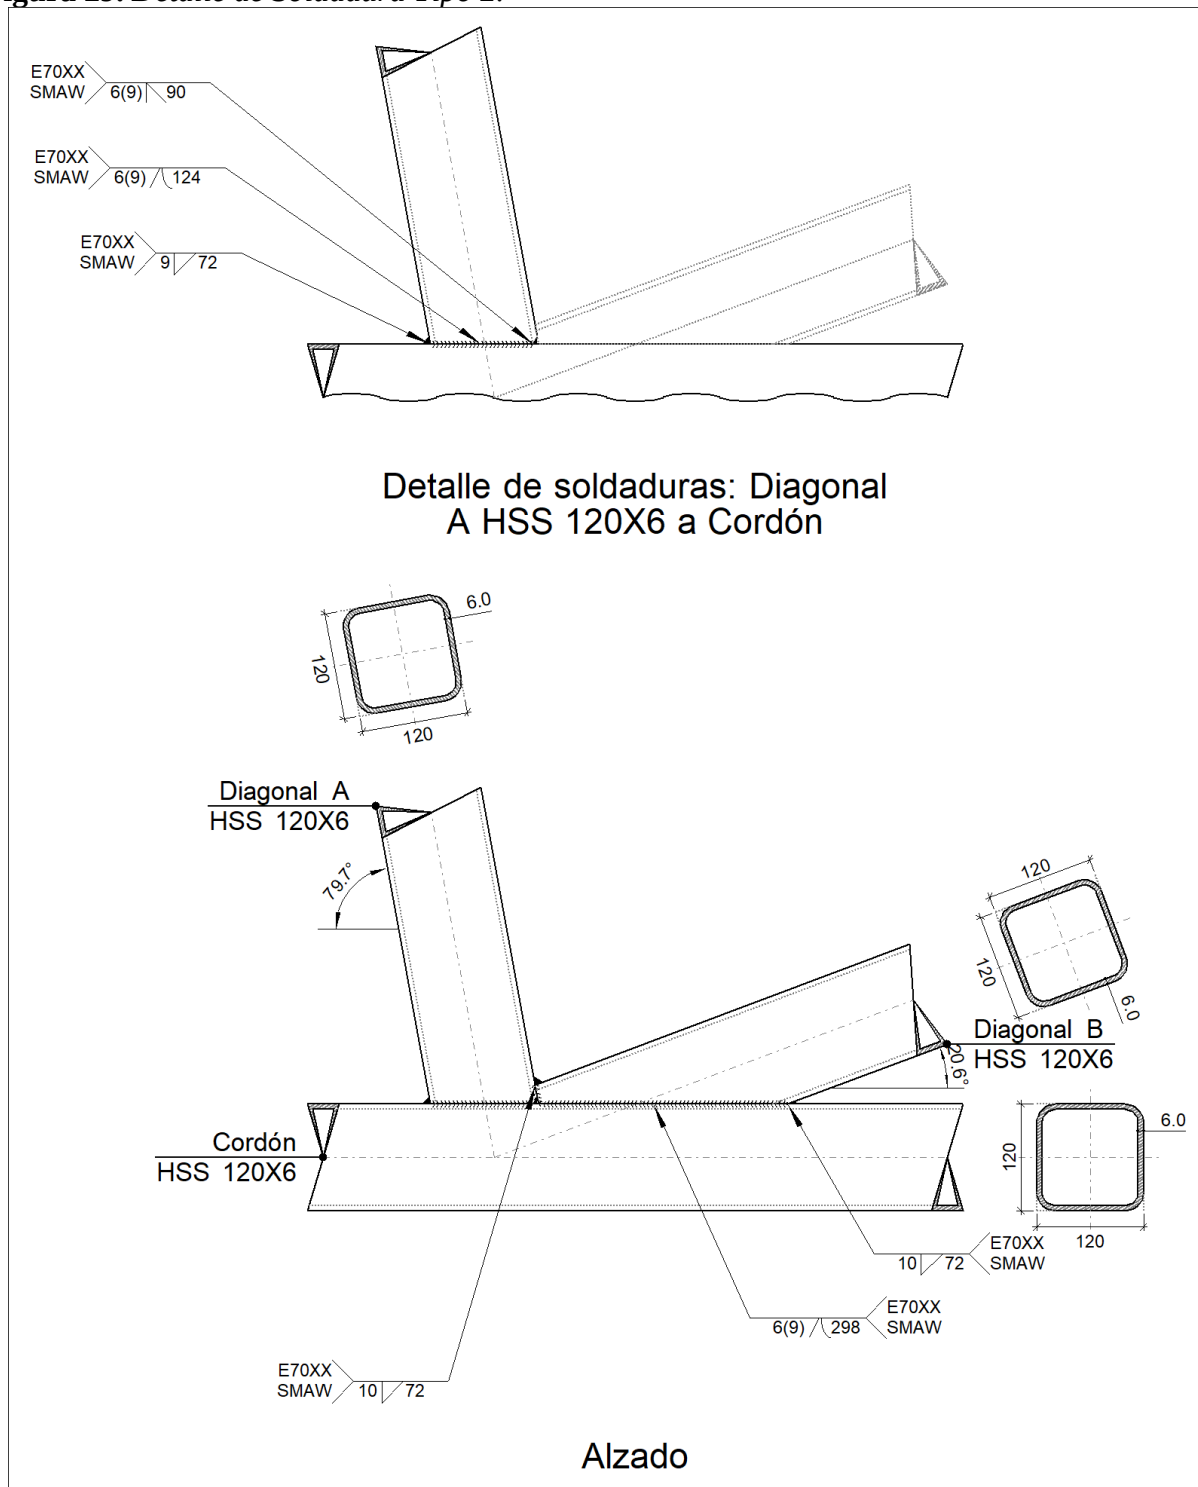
Detalle de Soldadura Tipo 2.
